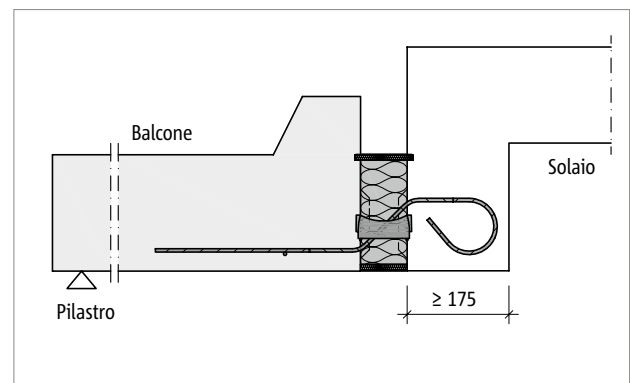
Schöck Isokorb® T tipo QL: situazione di montaggio "soletta del balcone prefabbricata"
